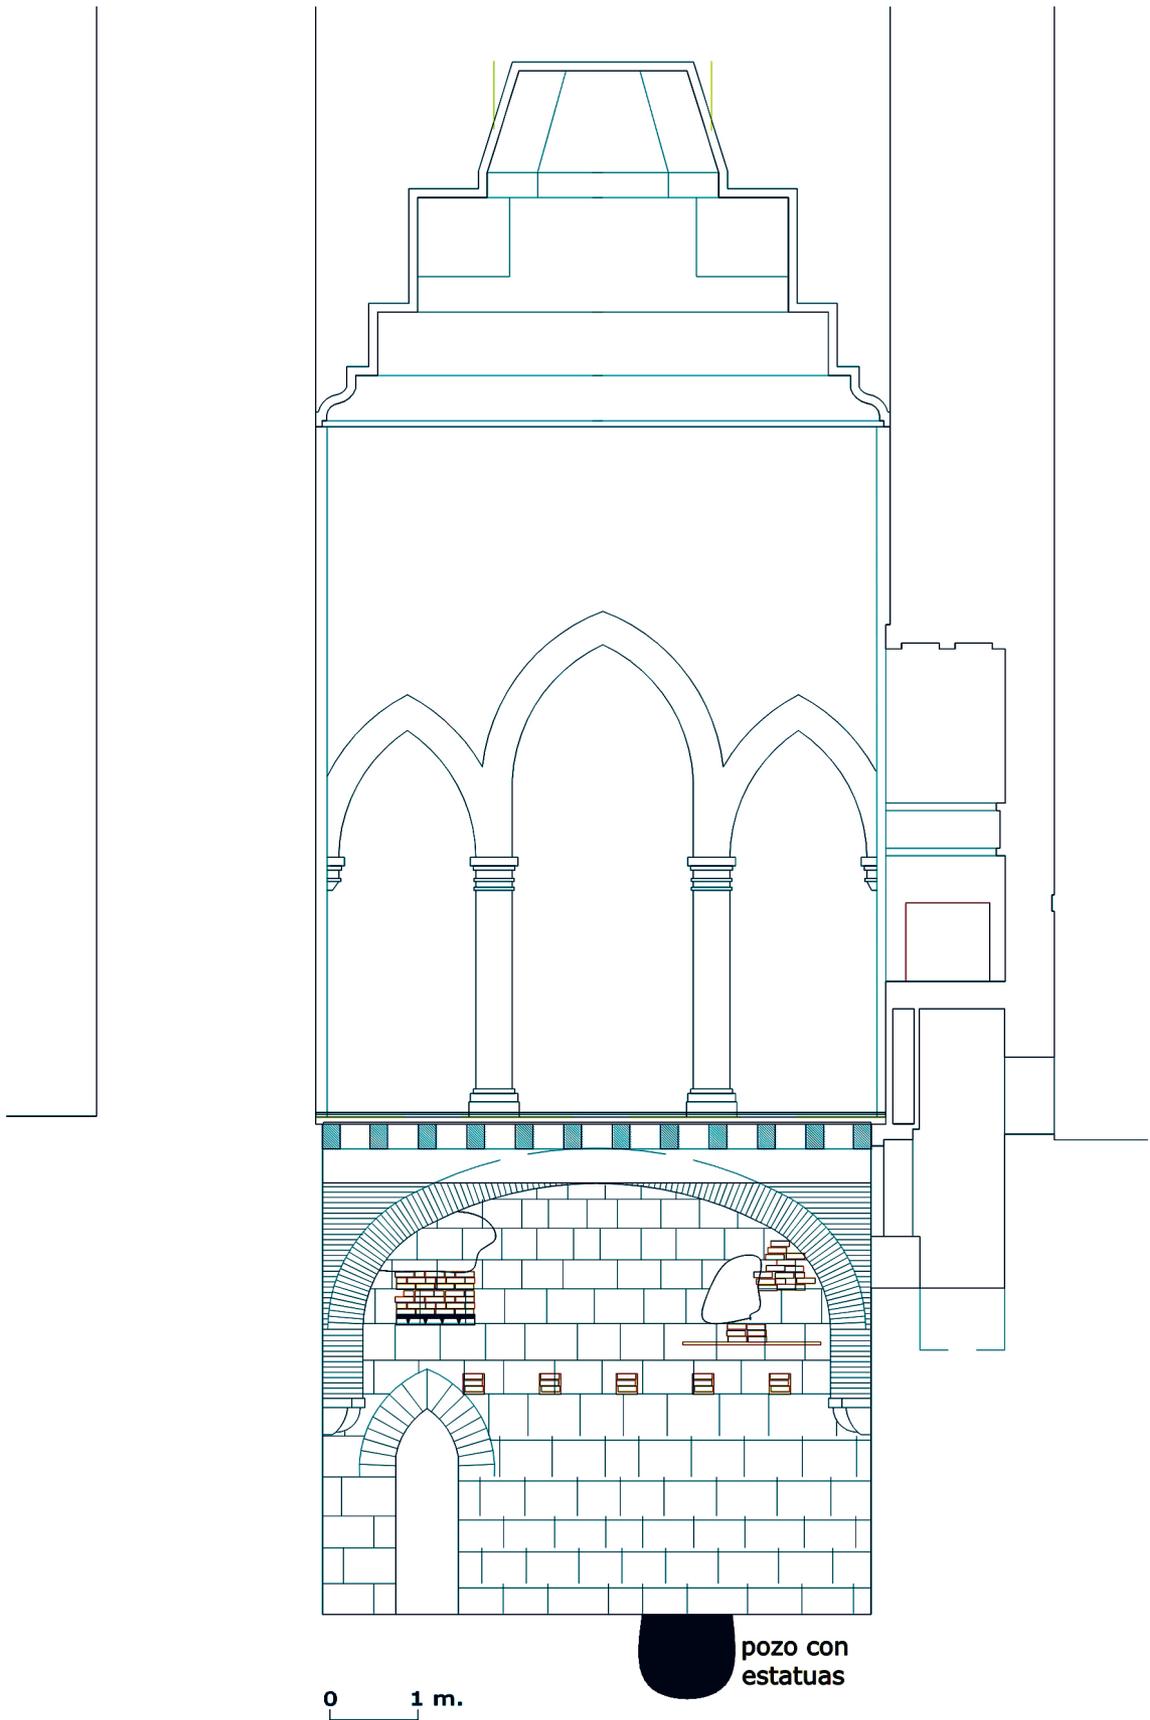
Alzado NO. Original realizado por el estudio de arquitectos PEMÁN Y FRANCO, modificado para la excavación
